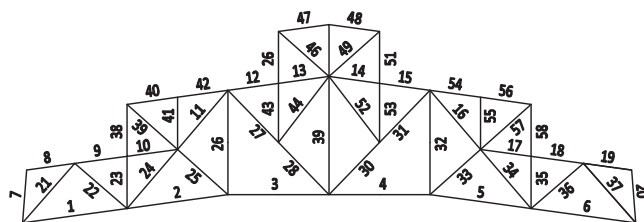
Przekrój poprzeczny przez więzary dachowy i konstrukcję wsporczą
